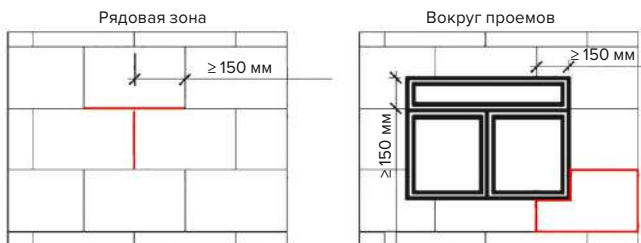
Схема установки плит на плоскости фасада и вокруг проемов
